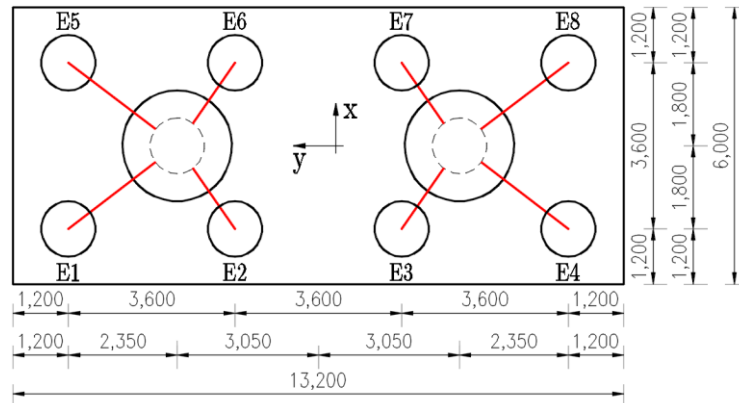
Planta e modelo de cálculo do maciço de encabeçamento
